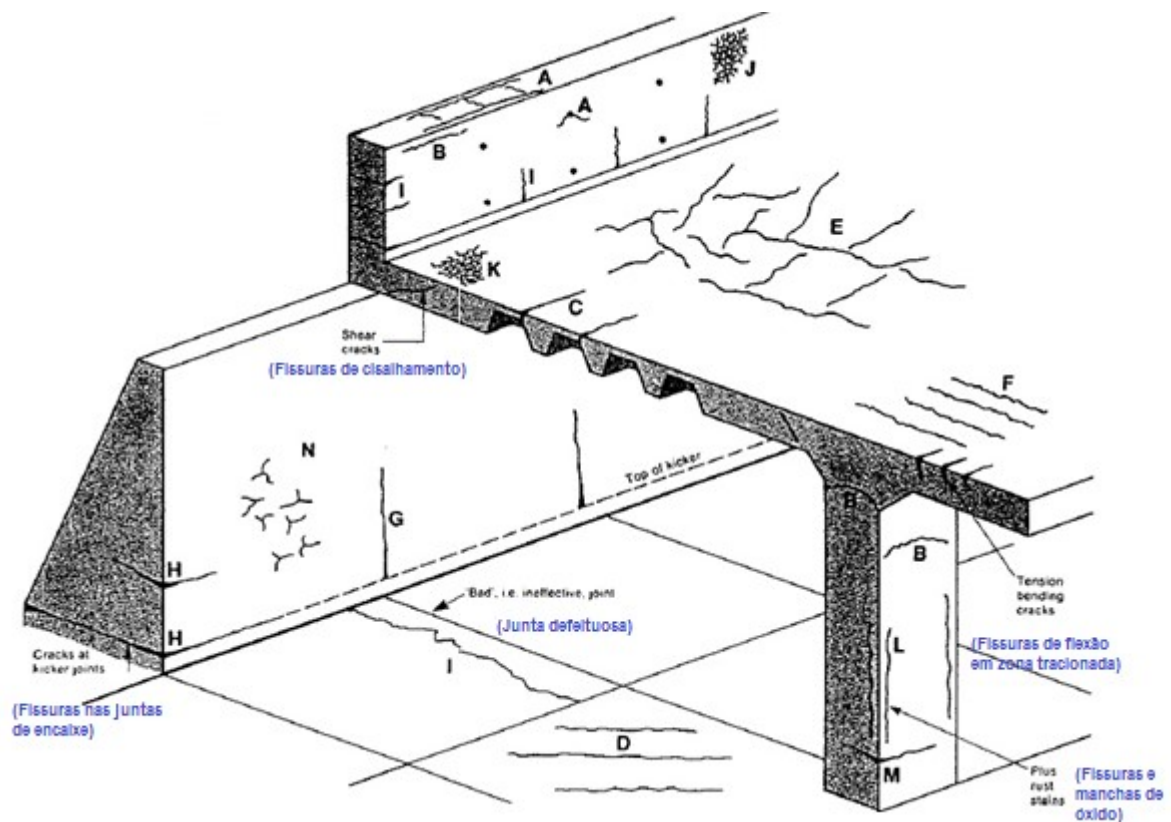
Exemplos de fissuras recorrentes em estruturas de concreto.
